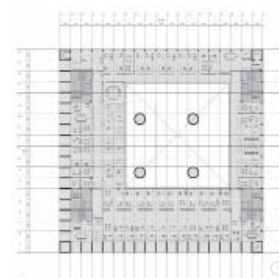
Banco Caja Baja, Granada, 2001. Arquitecto: Alberto Campo Baeza. Planta Baixa.
